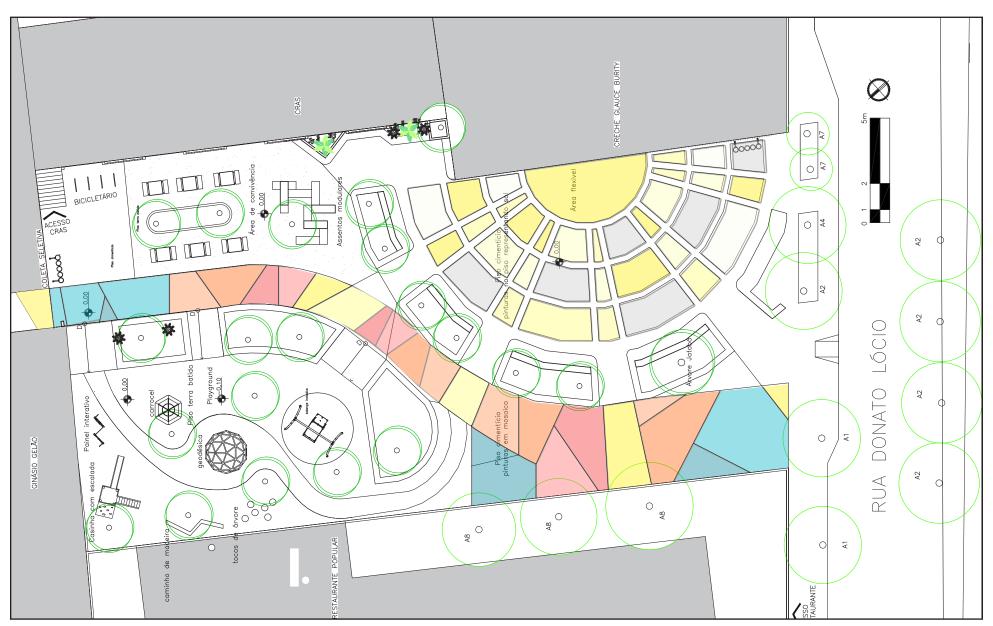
Planta de estudo preliminar para a Praça do Caminho do Sol - 01 Fonte: Autor, 2025.
